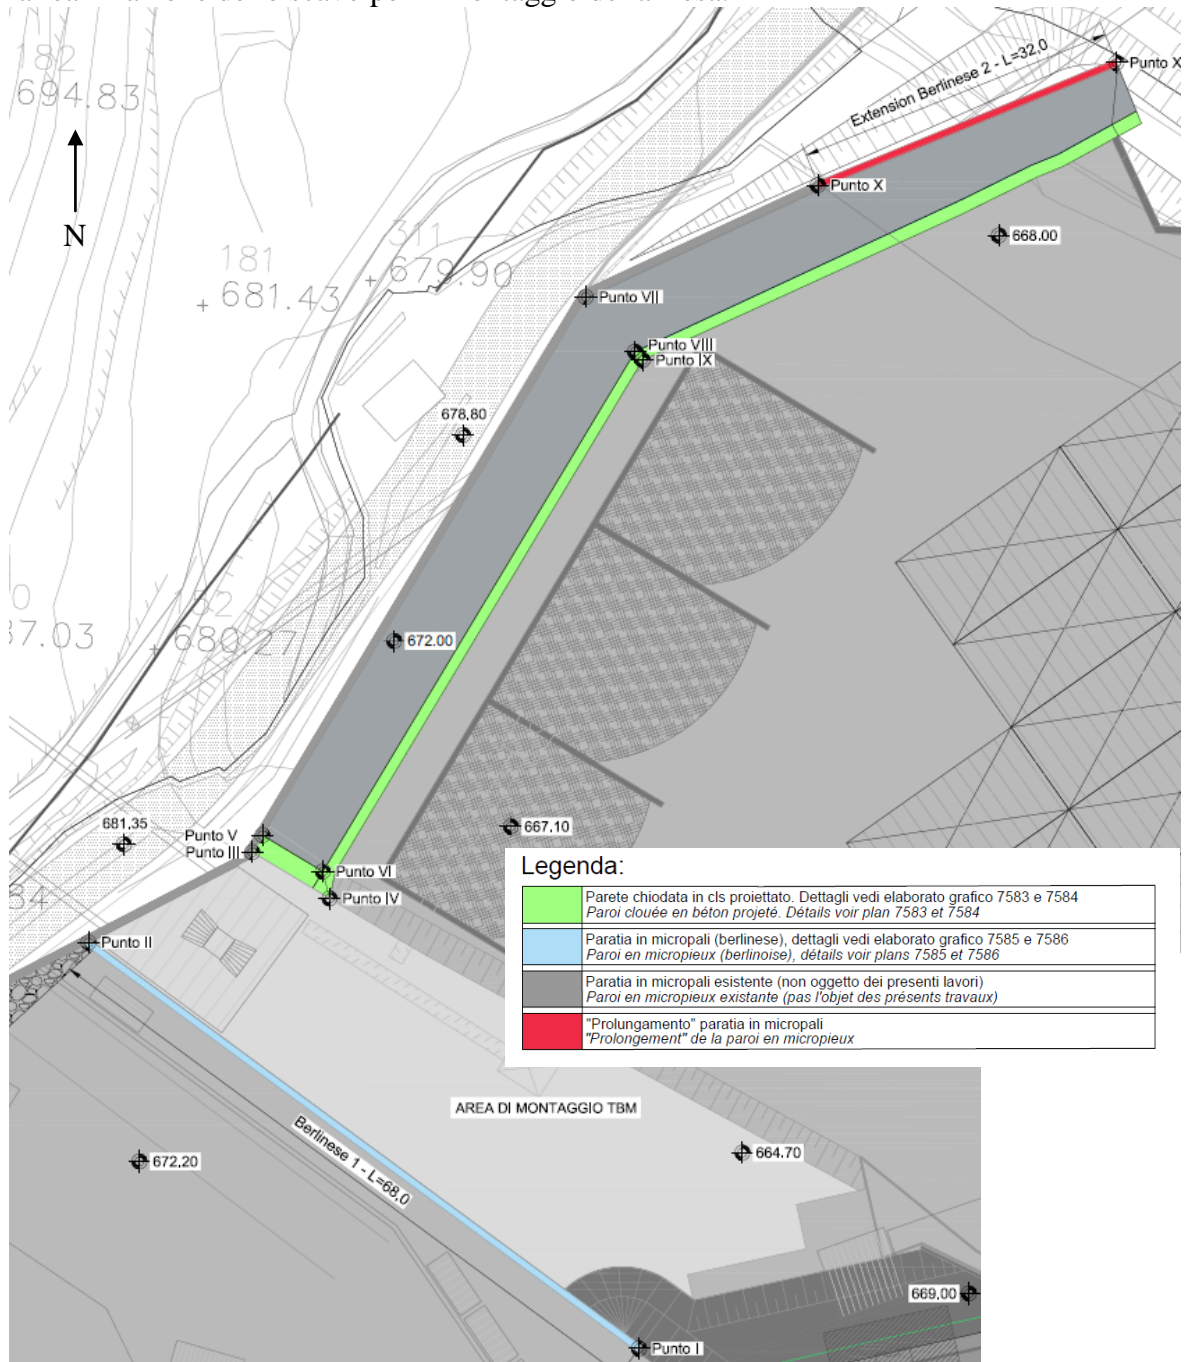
Estratto planimetria area di cantiere (dall'elaborato grafico n. PRV\_C3A\_7582)
